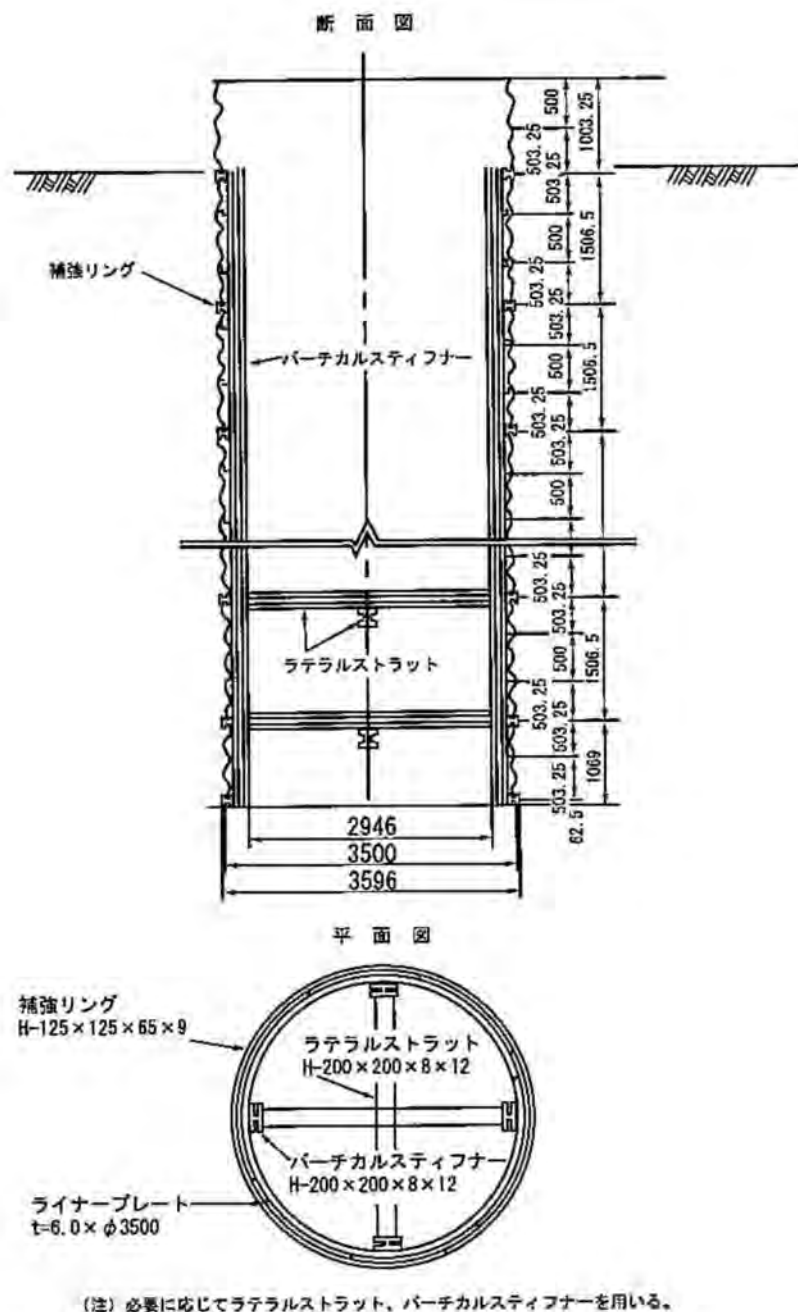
ライナープレートによる集水井の例 (単位 : mm)
